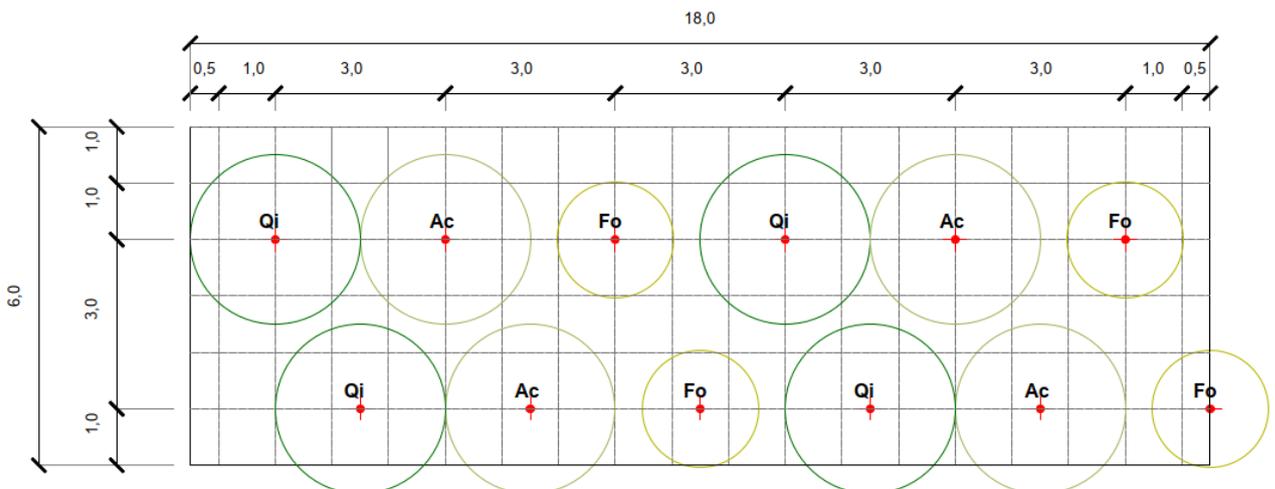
Planimetria del sesto d'impianto del MODULO D
